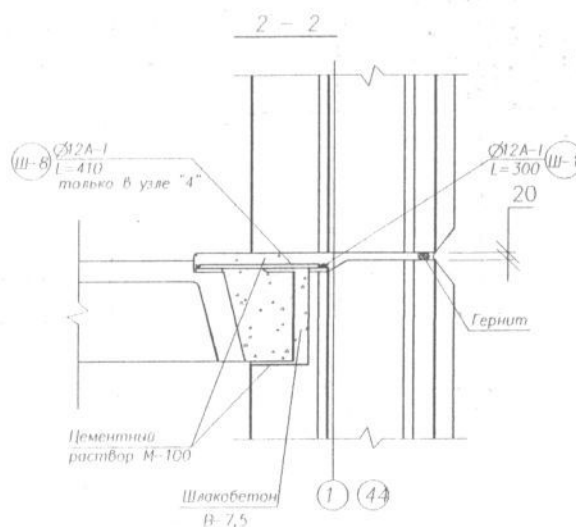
Стык наружных рядовых панелей и панелей перекрытия
